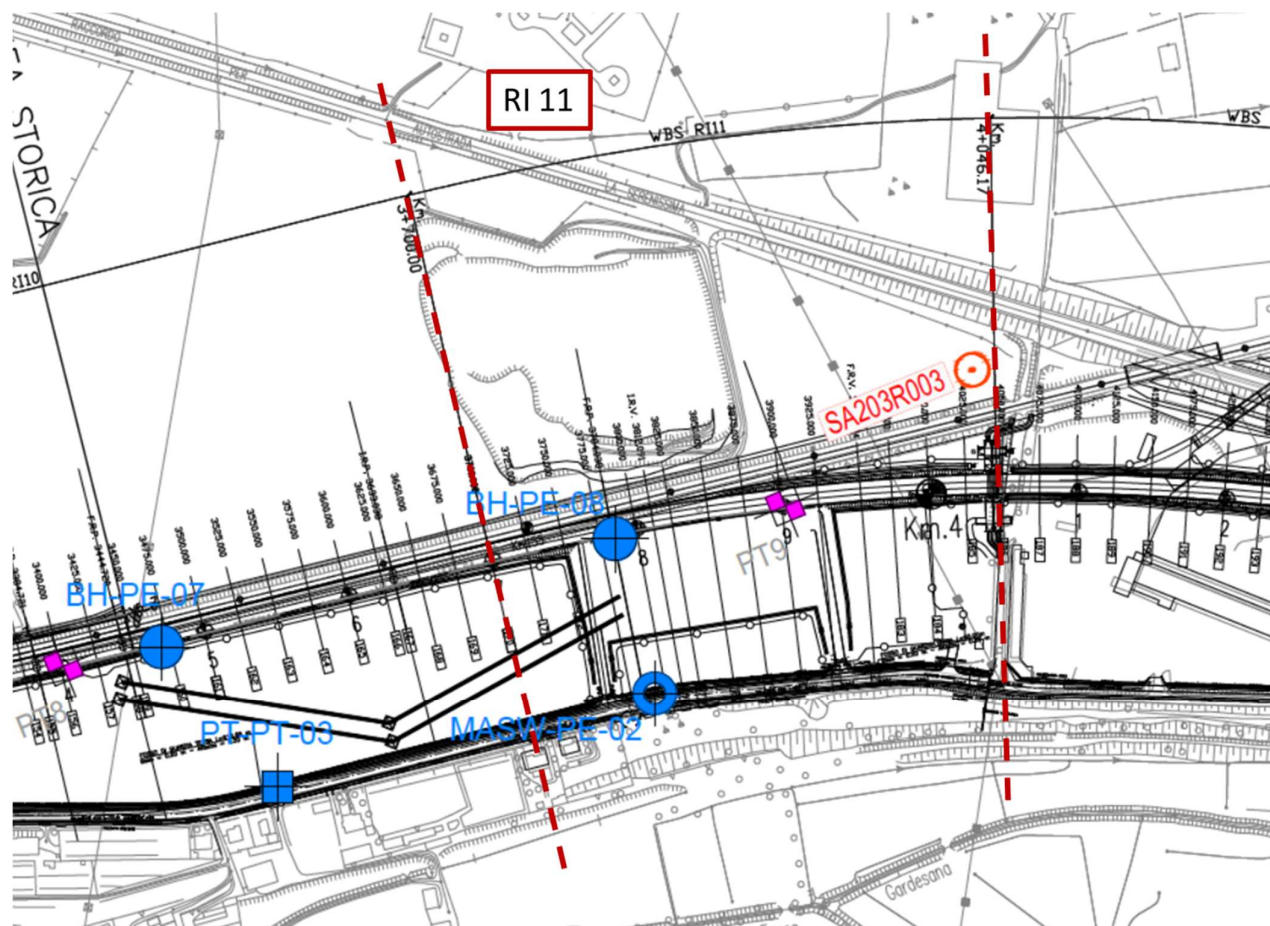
Planimetria Rilevato RI11, estratto dalla Planimetria Generale (Doc. Rif. [3])
